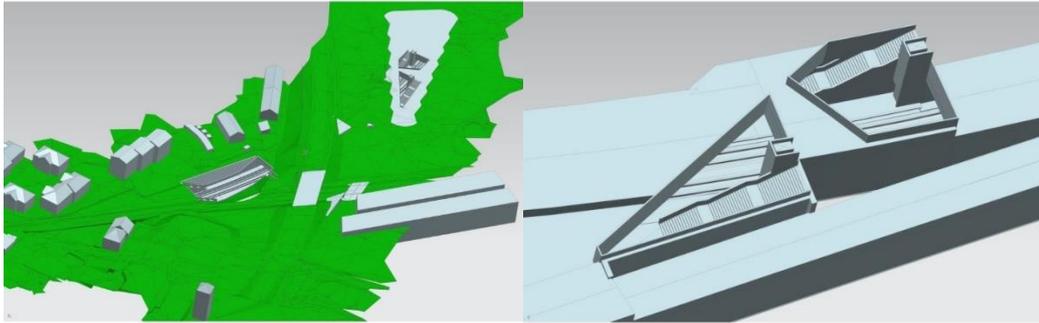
Station mit Bebauung und DGM, Detail Zugang 1 (Quelle: Obermeyer Planen + Beraten GmbH)
